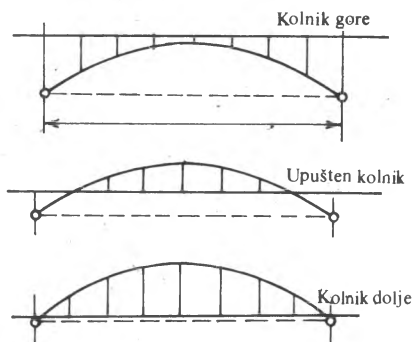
Vitki luk s krutom kolovoznom konstrukcijom
